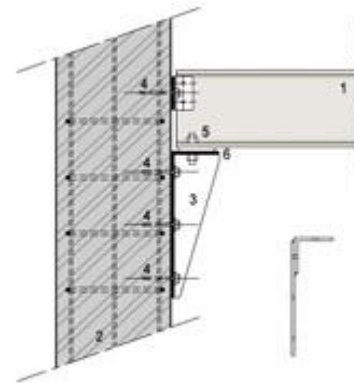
structure mixte poteaux béton armé poutres métalliques
